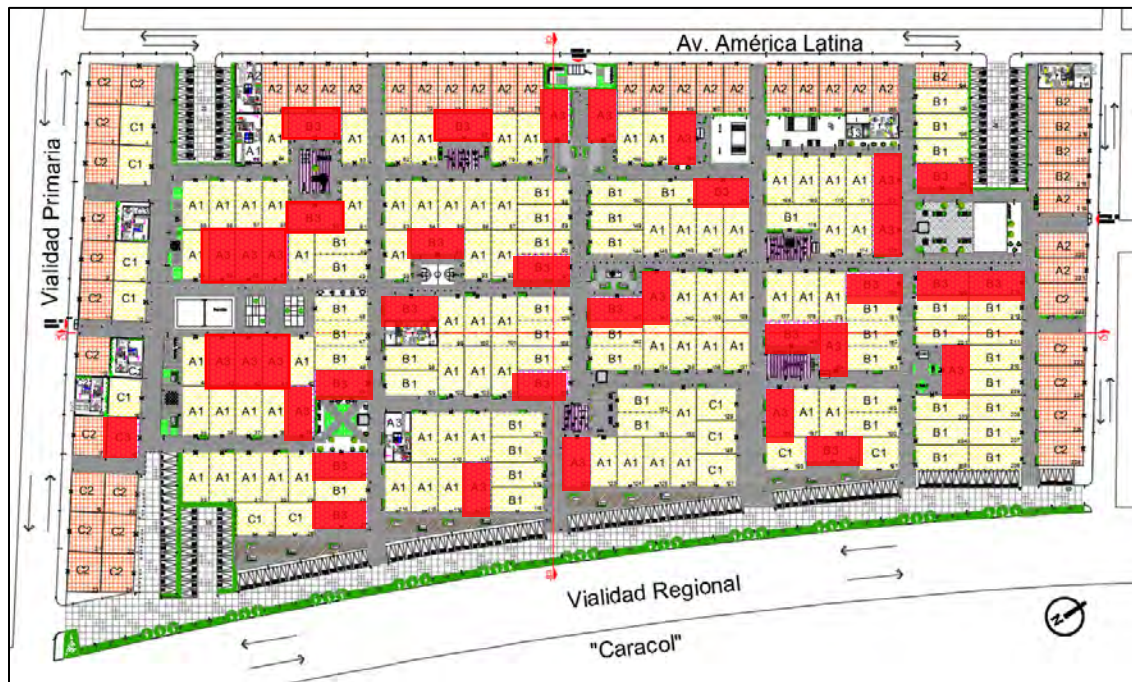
Planta de conjunto. Señalado con color rojo las viviendas tipo 3.
